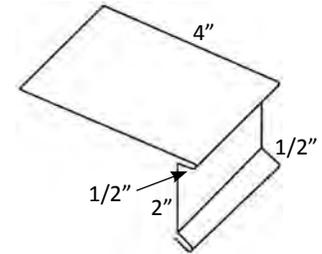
Dimensiones de tapajuntas de alero con teja Ludowici para debajo de la teja del alero (Under Eave)
